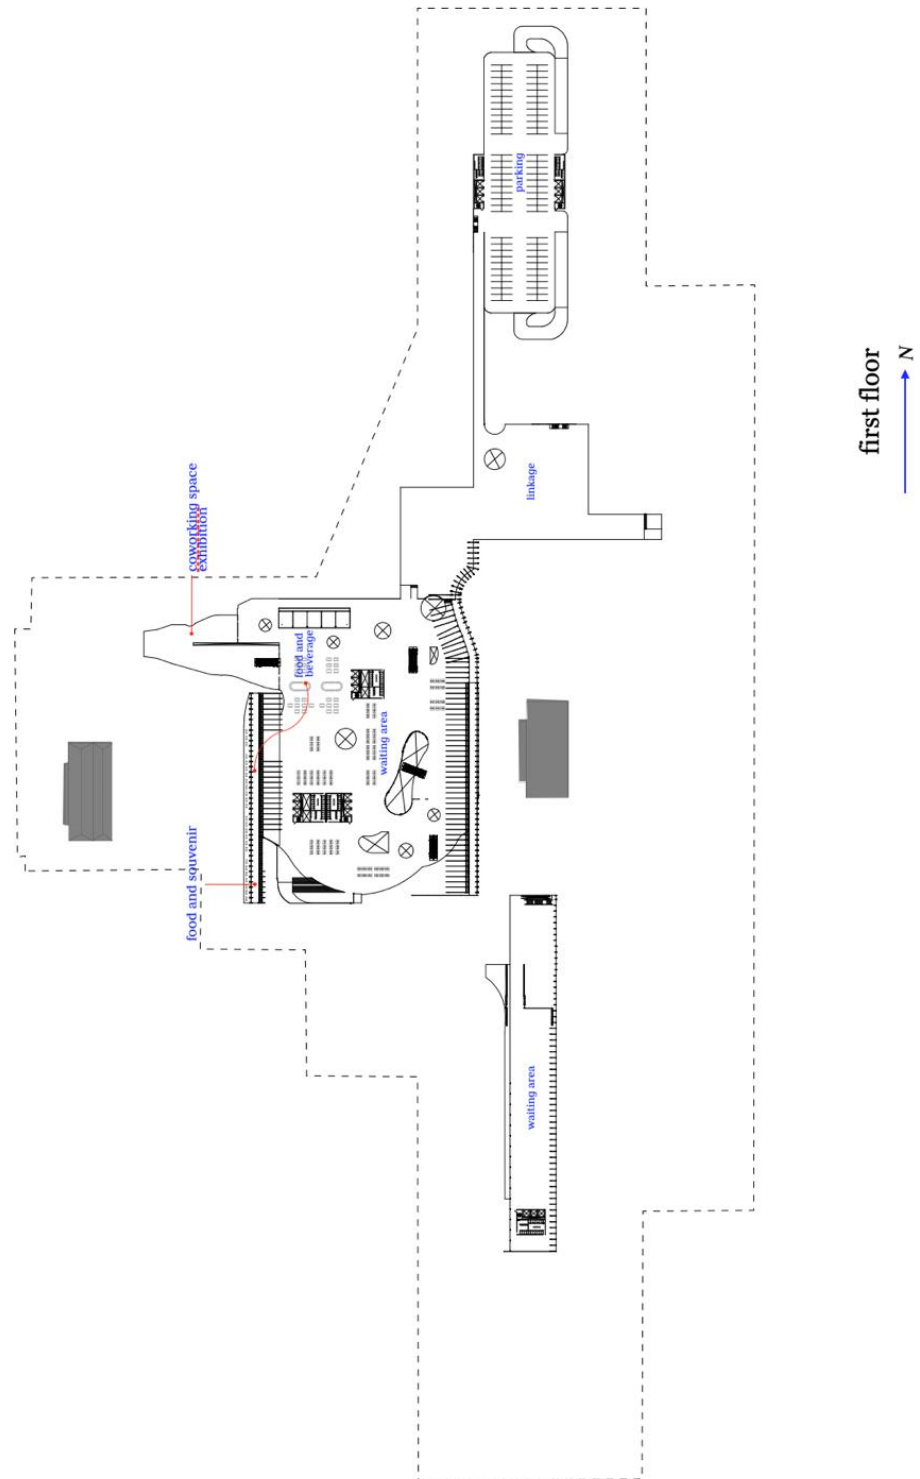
สถานีรถไฟในแบบร่างชั้นที่ 9 Layout plan
